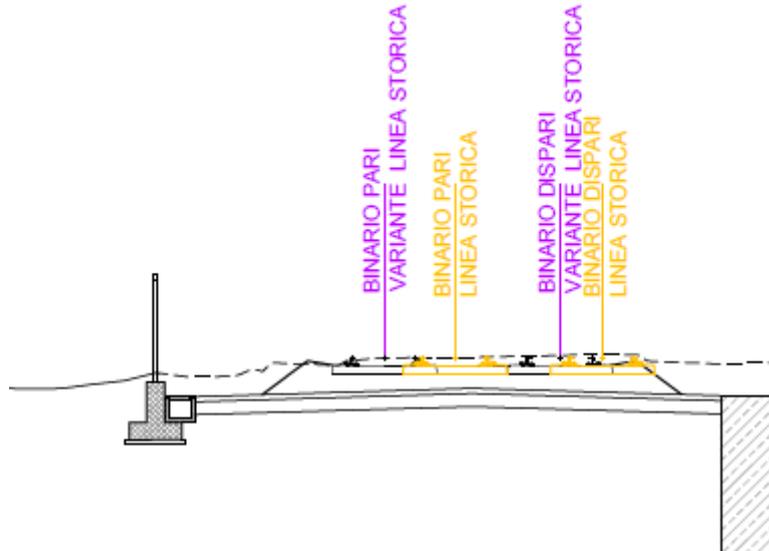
Sezione degli interventi (in viola la variante della linea storica)
